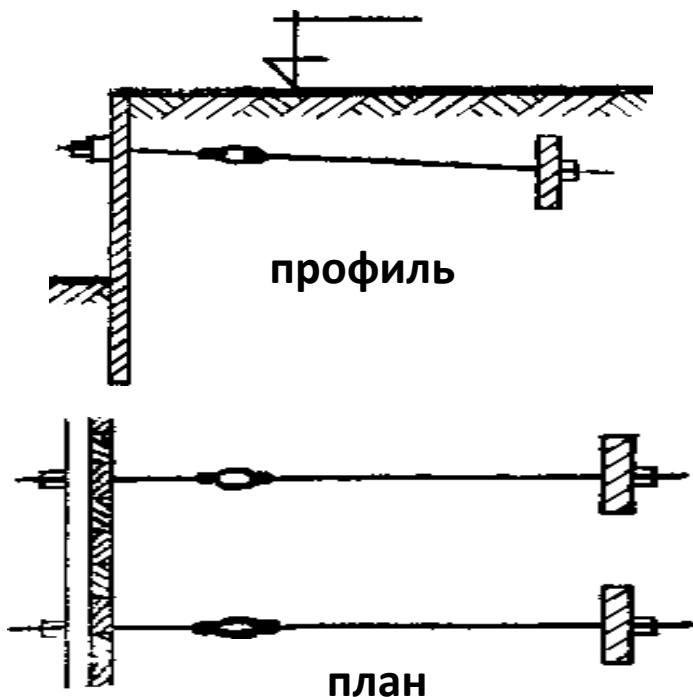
Расчетная схема заанкерванной тонкой подпорной стенки
